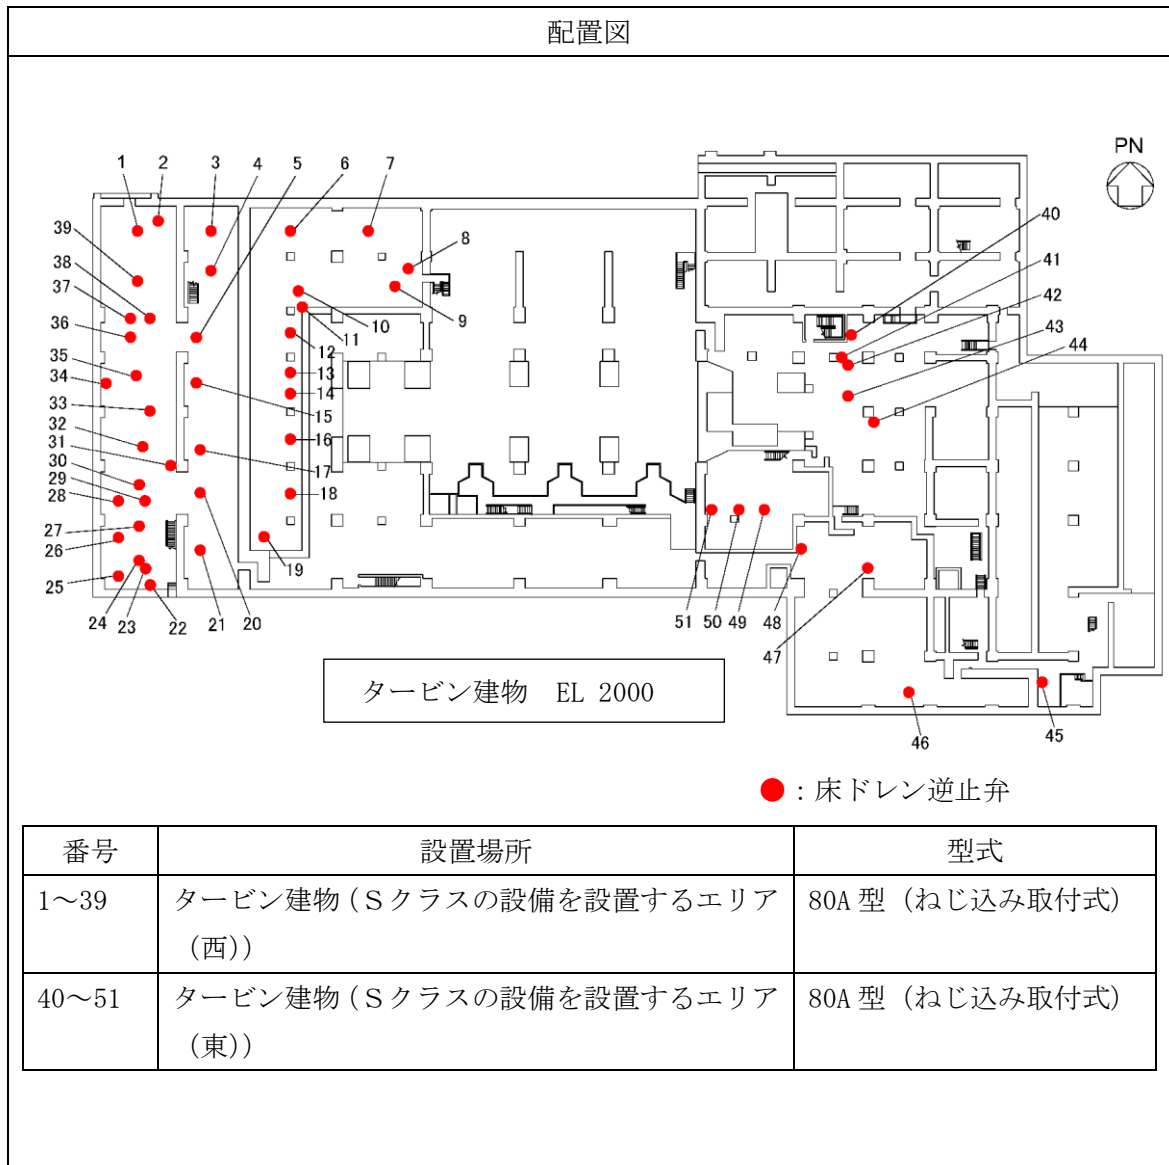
床ドレン逆止弁の設置位置図 (2/3)
